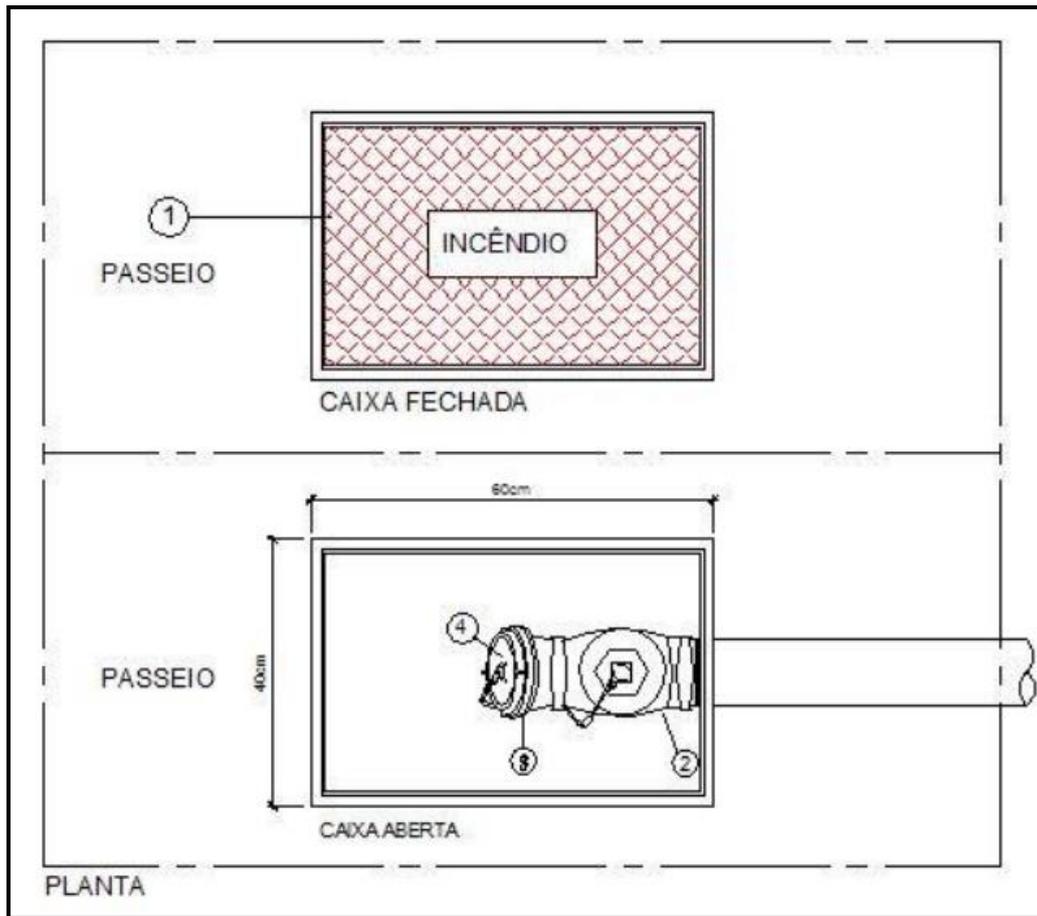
HIDRANTE DE RECALQUE – PLANTA
